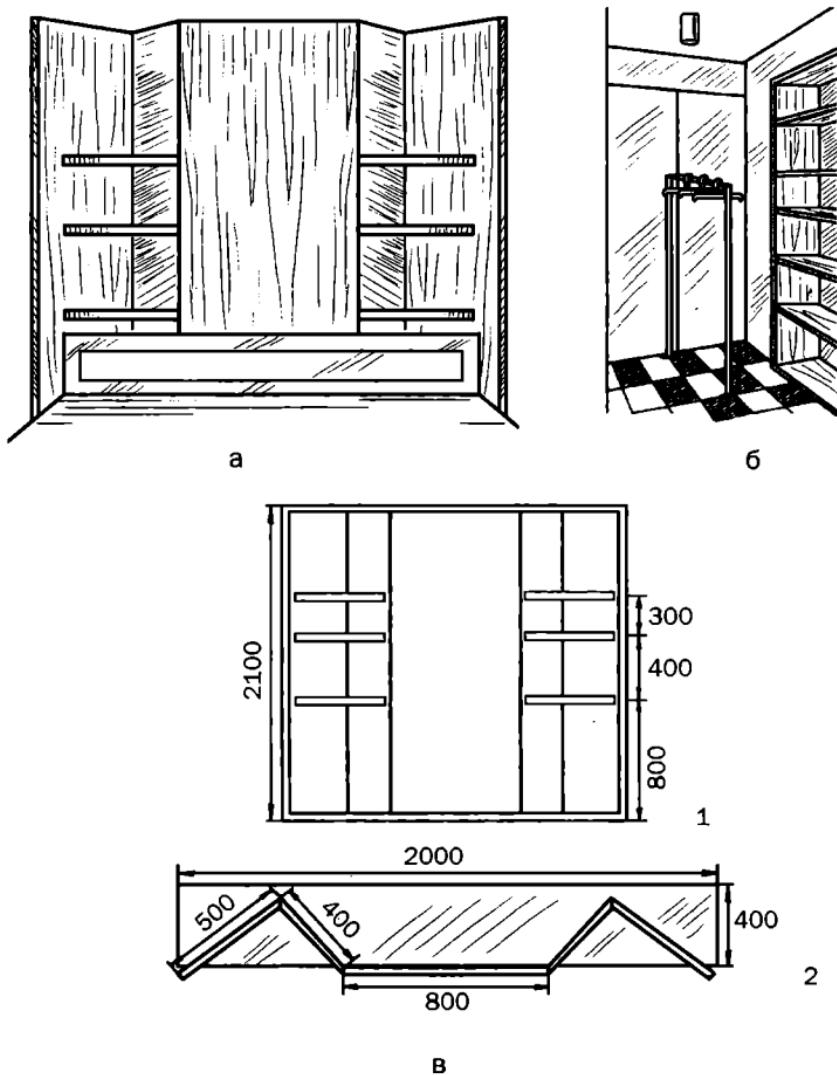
Мини-гардеробная в спальне (размеры указаны в миллиметрах): а — общий вид стеллажа; б — общий вид гардеробной; в — стеллаж-перегородка: 1 — вид спереди; 2 — вид сверху
